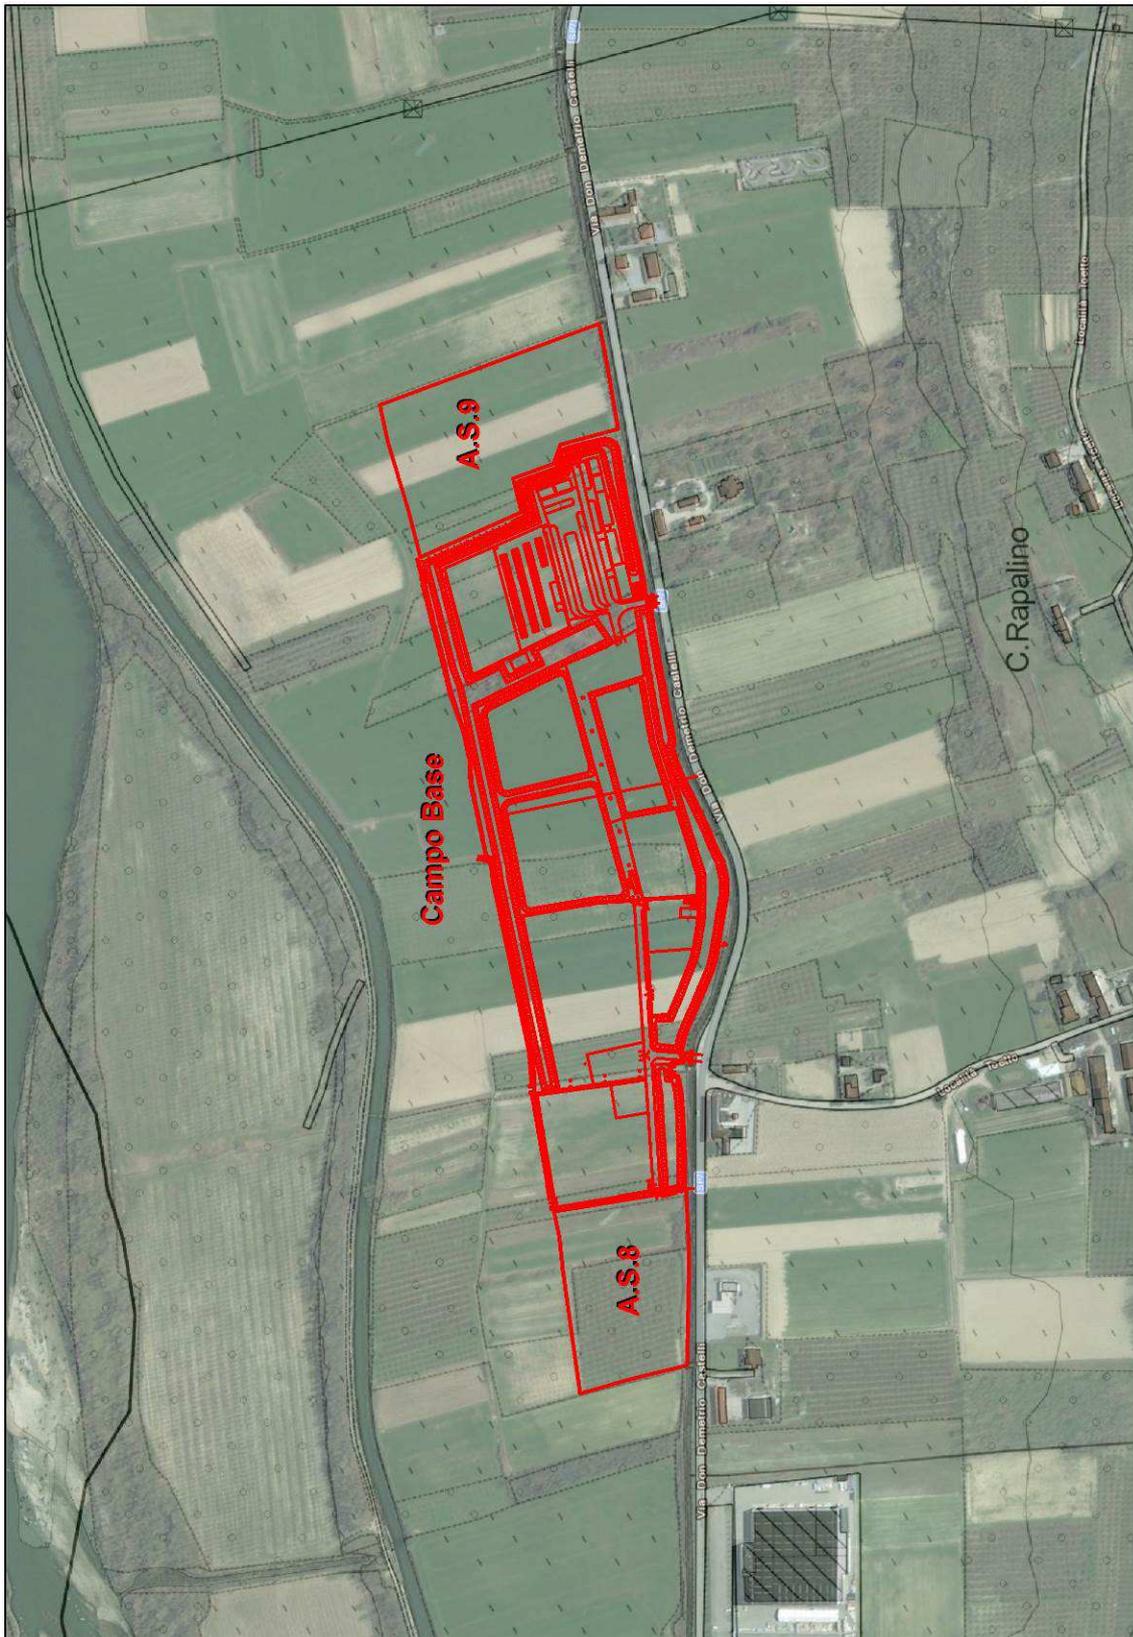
A – Localizzazione cantiere Campo Base (A.S.8 e A.S.9)
